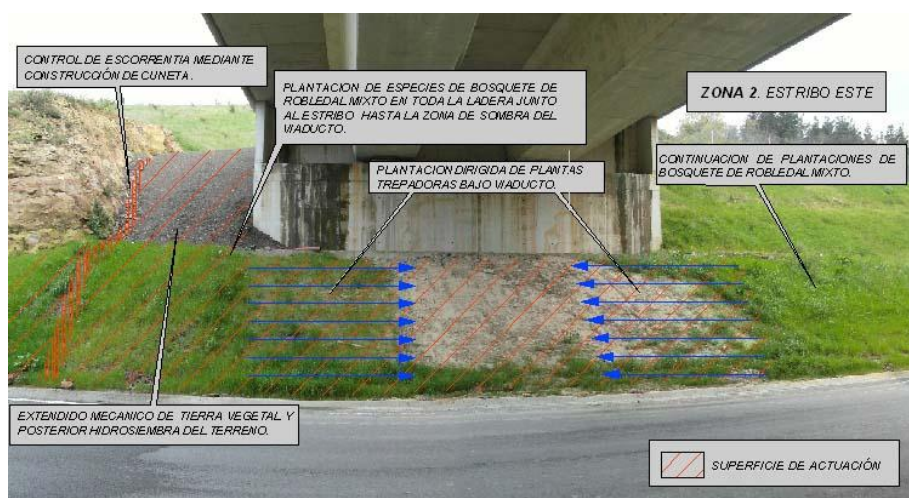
Zona 2, superficie junto a estribo y bajo el viaducto.
